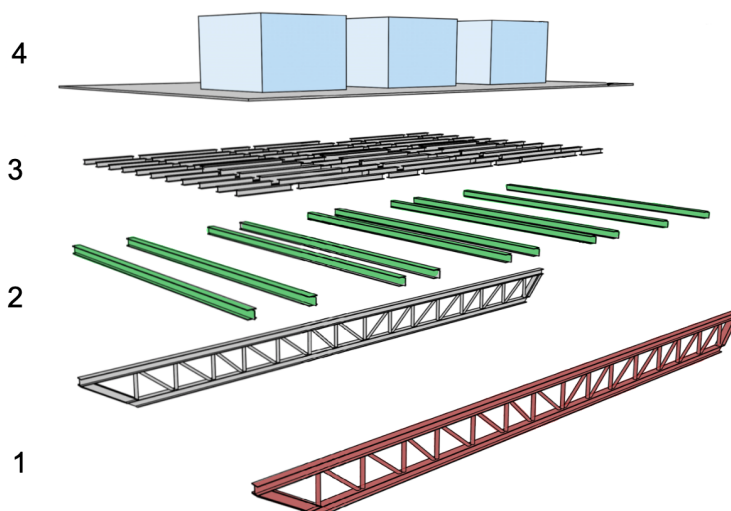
Composition structurelle détaillée du plancher du projet SEGAL [11]
